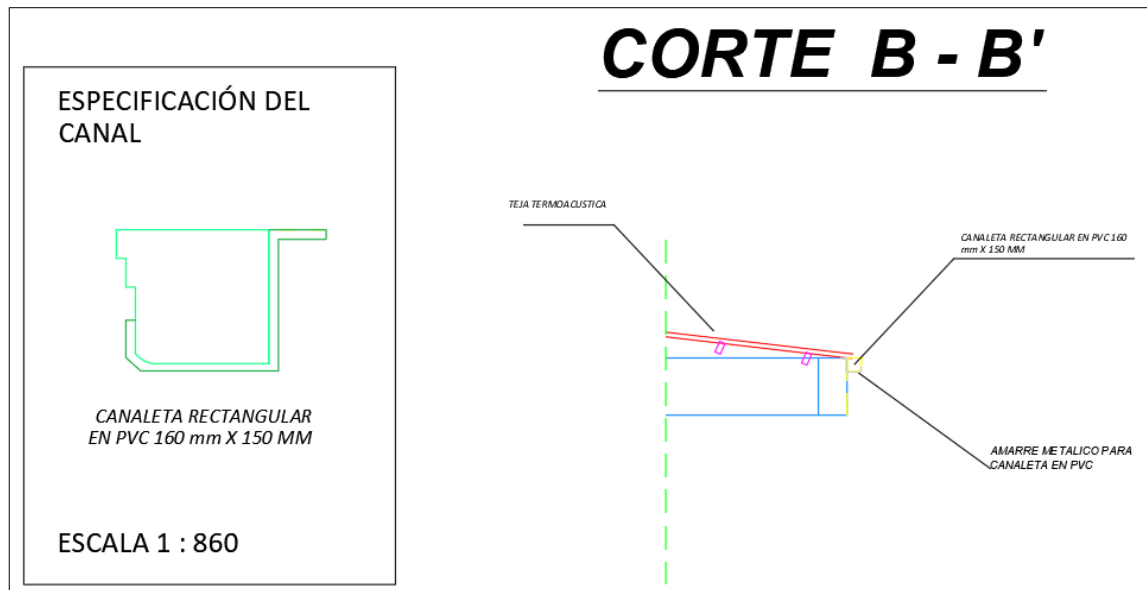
Corte arquitectónico B-B', de la estructura 3 del Centro de Desarrollo Infantil.
